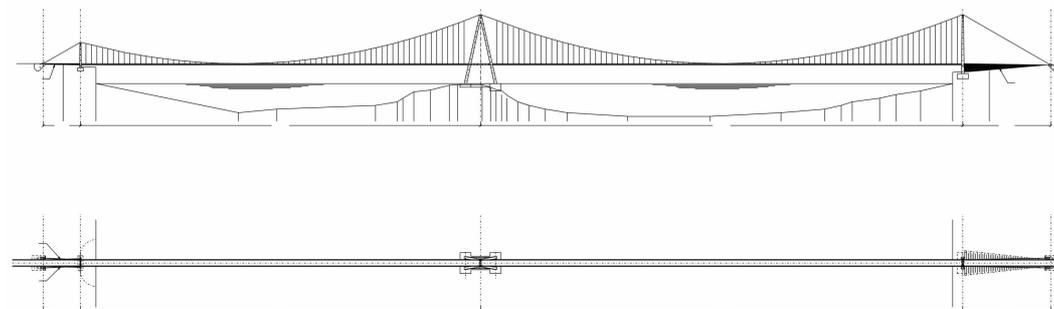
Planta y alzado. Solución puente colgante de dos vanos.
